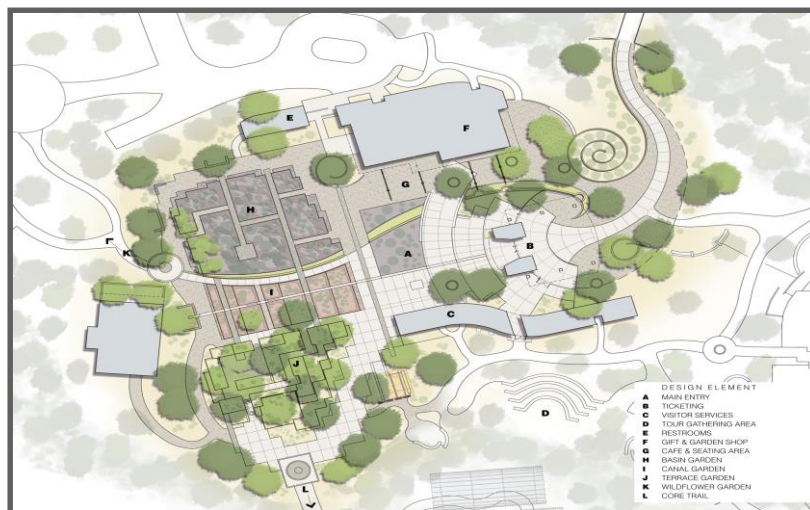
Plan Maestro Jardín Botánico de Phoenix.
